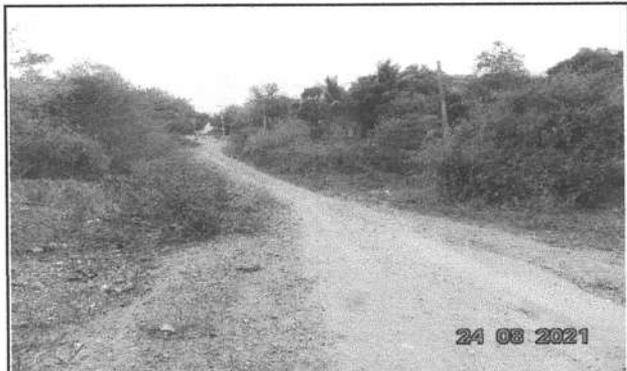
LOCAL DA CONSTRUÇÃO - BUEIRO
